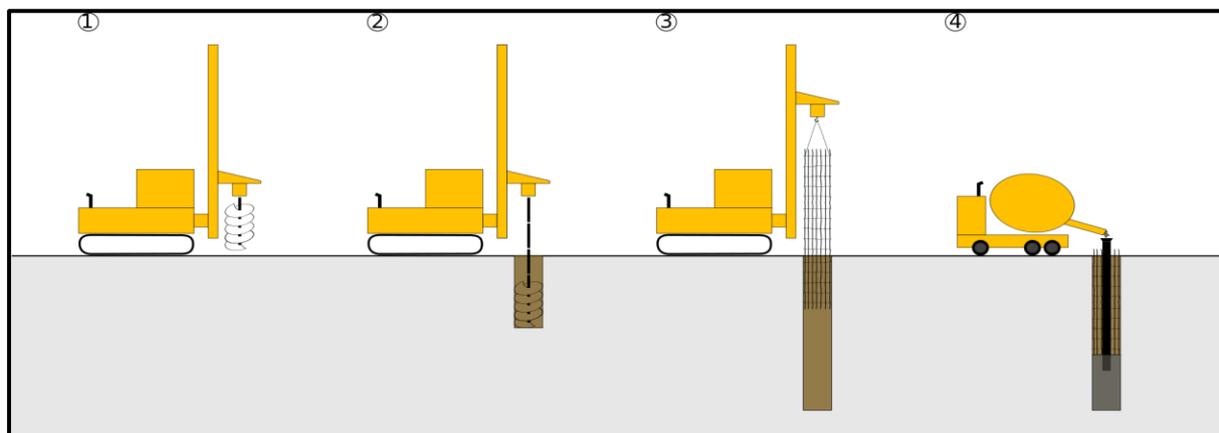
Les pieux de fondation. Source : Wikipédia
